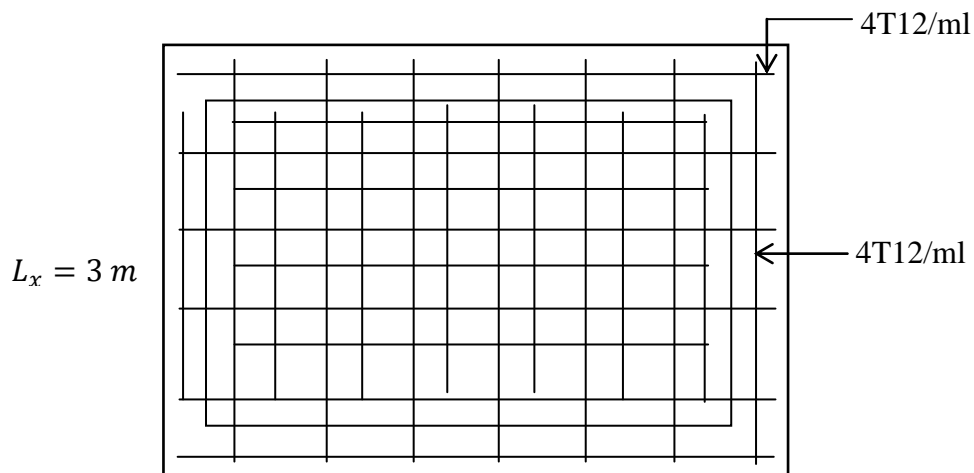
Ferrailage inférieur de la dalle de l'ascenseur
